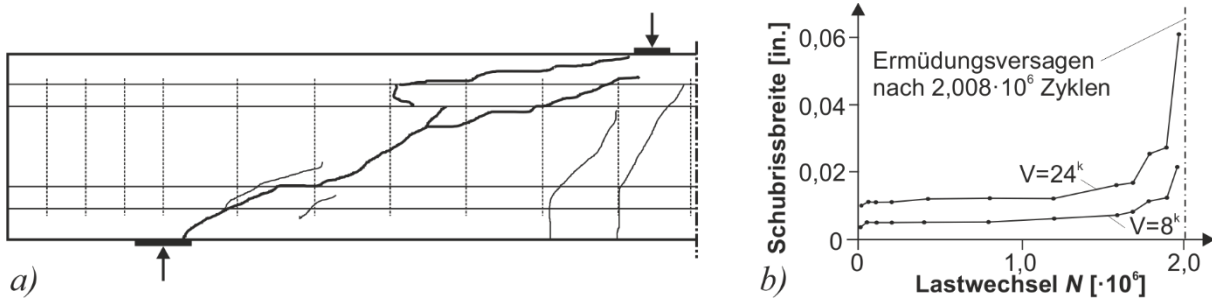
Spannbetonträger nach /Han65/: a) Rissbild im Bruchzustand; b) Schubrissbreiten unter Ober- und Unterlast
